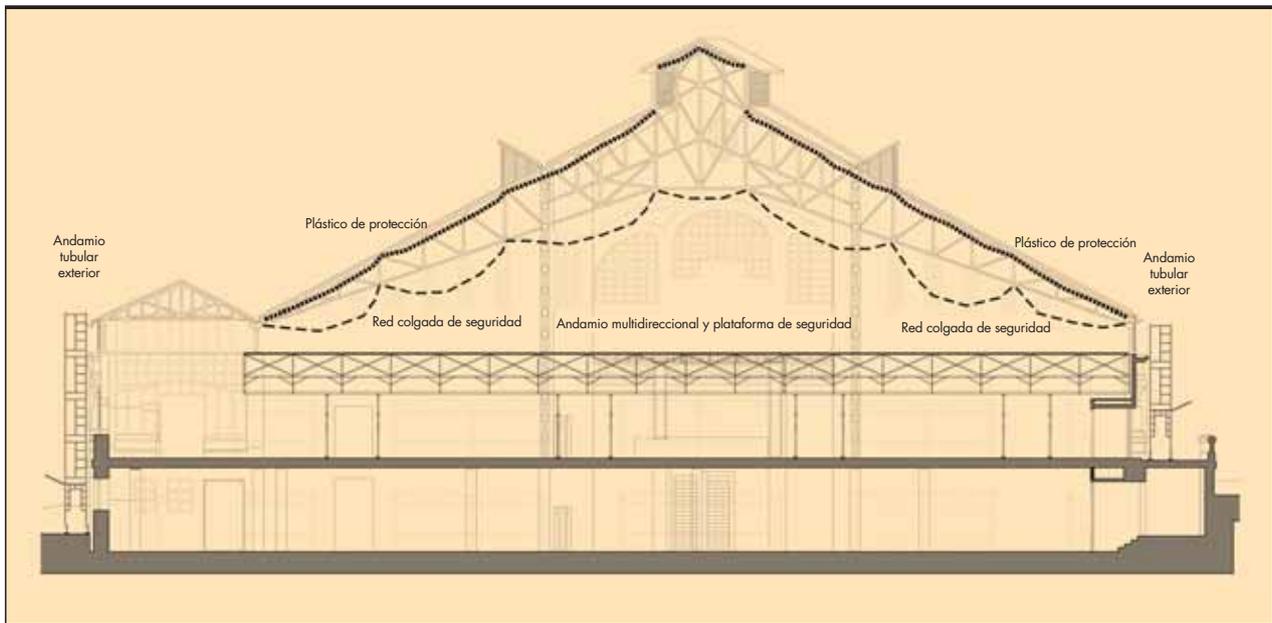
Sección del Proyecto de Deconstrucción (2007).
